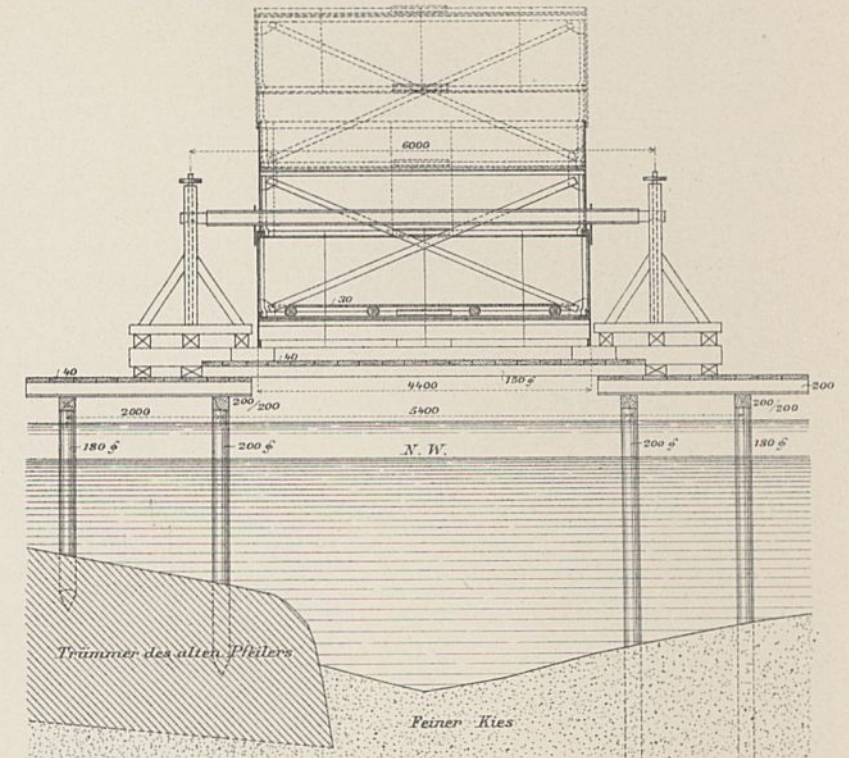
Eiserner Blechmantel nebst Aufstellungsgerüst für die Betongründung des neuen Strompfeilers.
